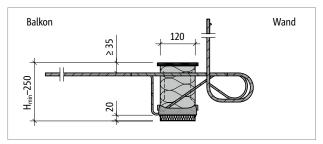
Schöck Isokorb® XT Typ K-WO: Produktschnitt
